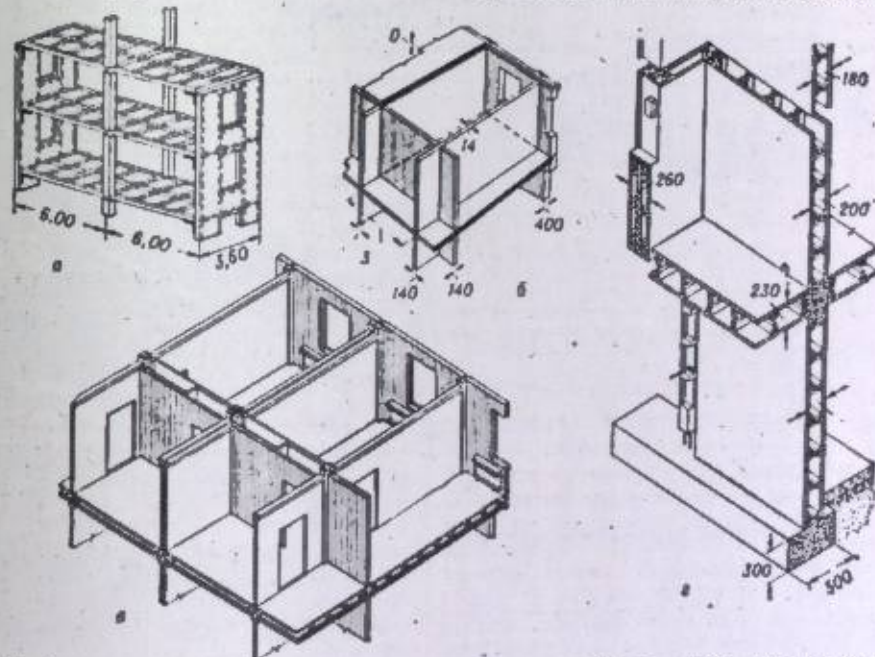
Железобетонные конструкции крупнопанельных домов: а — схема дома с неполным каркасом; б — схема бескаркасного дома с перегородками, работающими на сжатие; в — конструкция дома с перегородками, работающими на изгиб; г — конструкция дома из часторебристых панелей, изготовляемых методом вибропроката.
